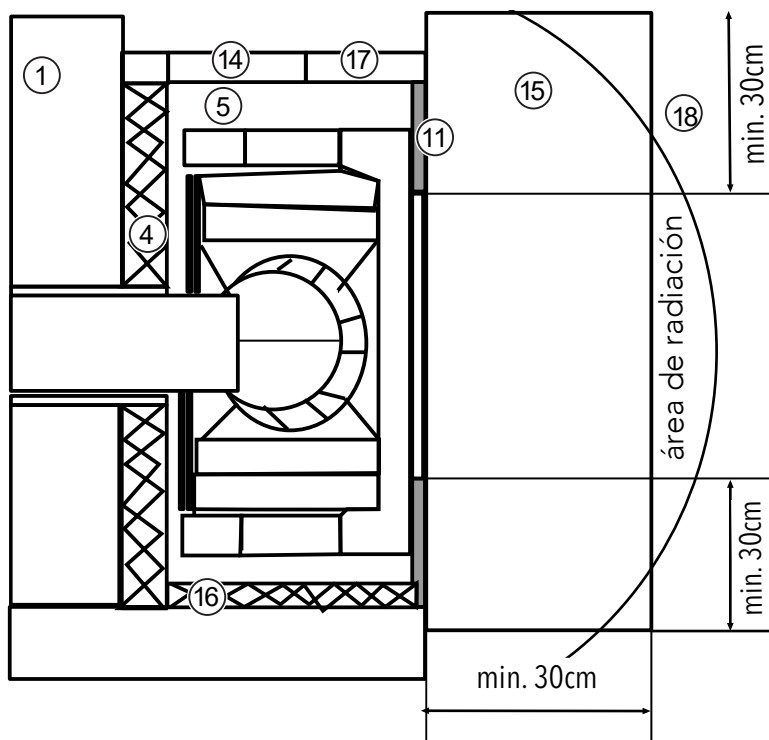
Disposición delante / al lado de una pared para ser protegida
